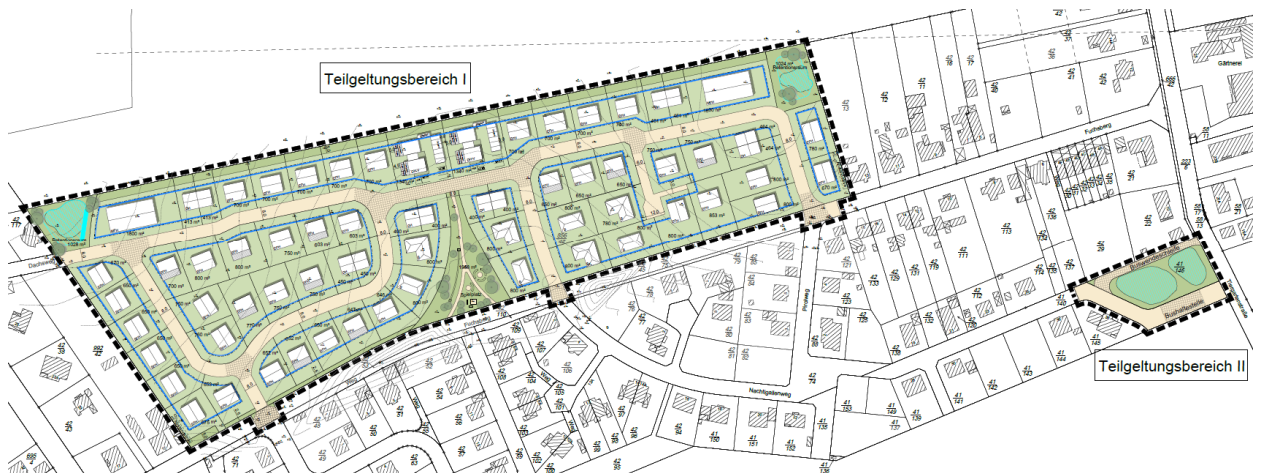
Städtebaulicher Entwurf (Quelle: Planungsbüro Patt, Lüneburg)
